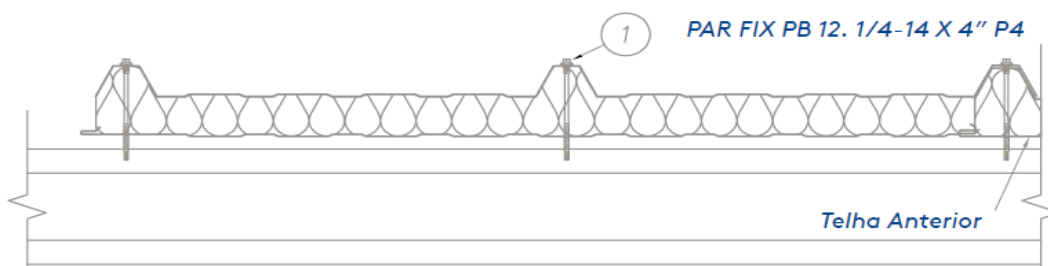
Parafuso de fixação, vista transversal da telha termoacústica.
